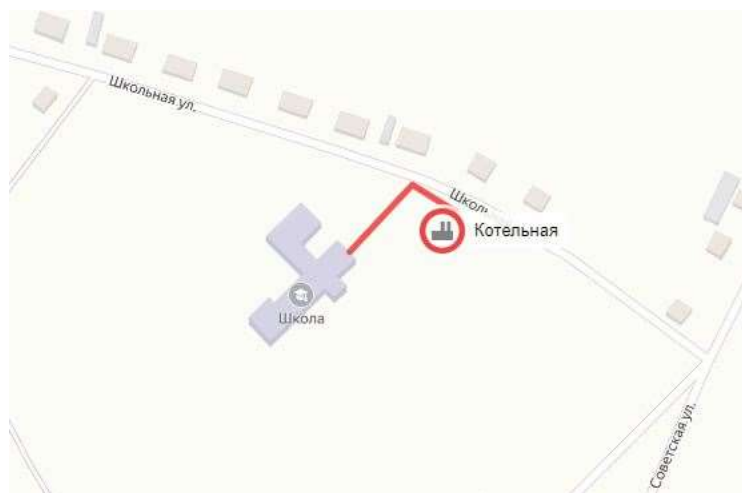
Схемы тепловых сетей от котельной № 26 с. Актабан
